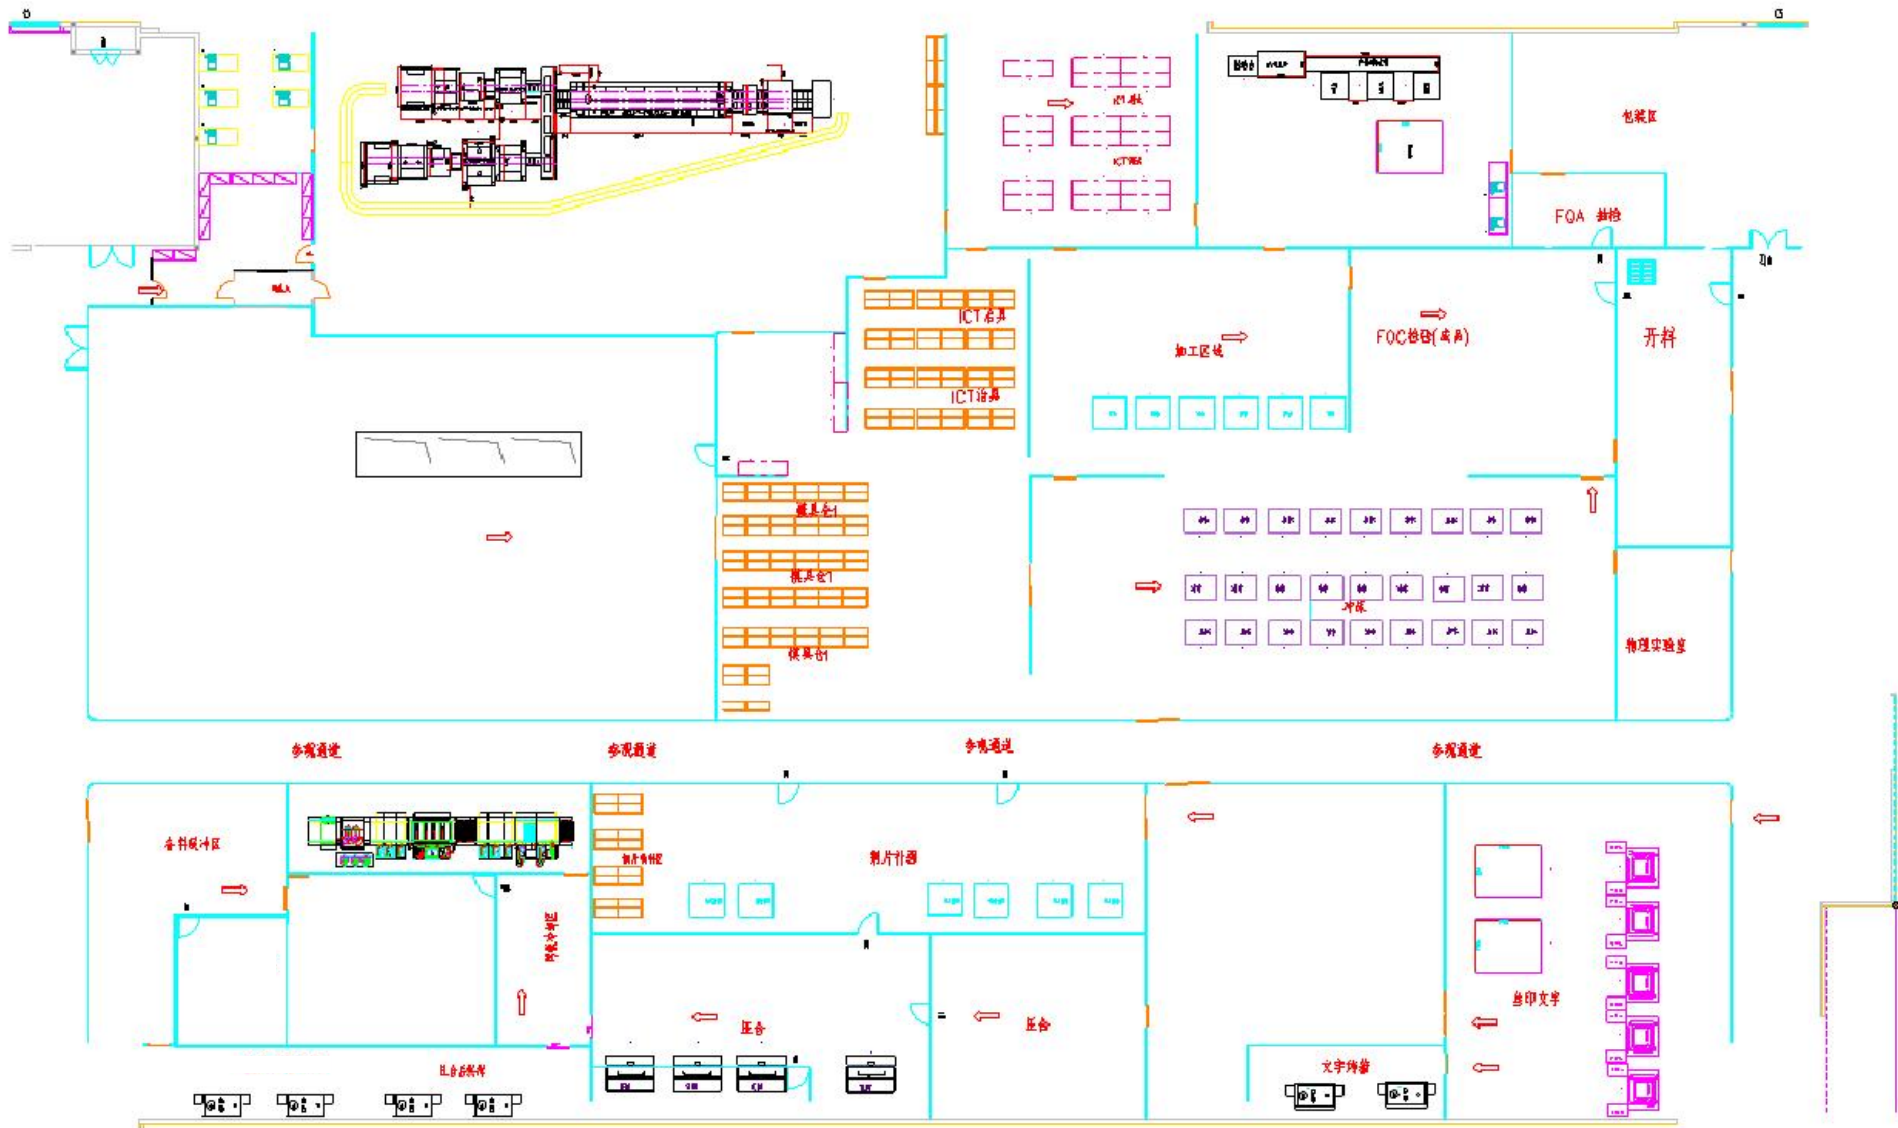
本项目二号厂房 7 楼实际平面布置图
